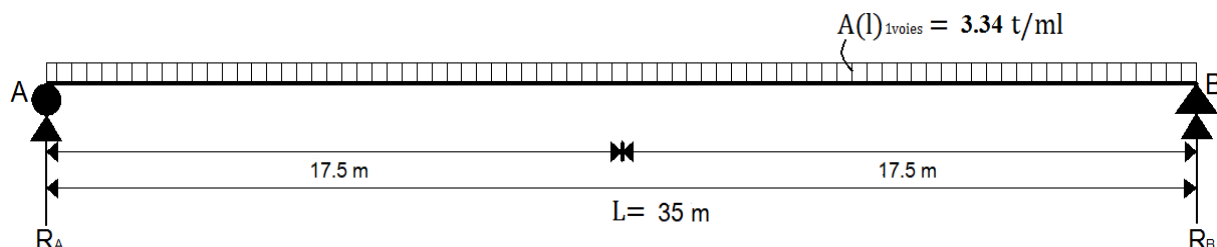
Schéma statique d'une poutre sous la surcharge A(L).
